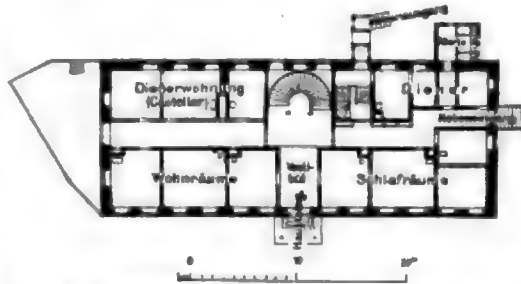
Erdgeschoss-Grundriß des Rossinischen Baues (1736).
